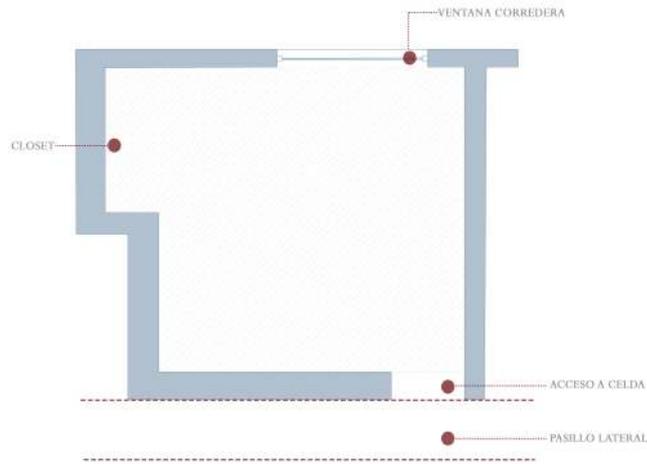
Planta de las celdas de los presos. | Fuente: Elaboración propia en base a plano de Tres y Cuatro Álamos.
